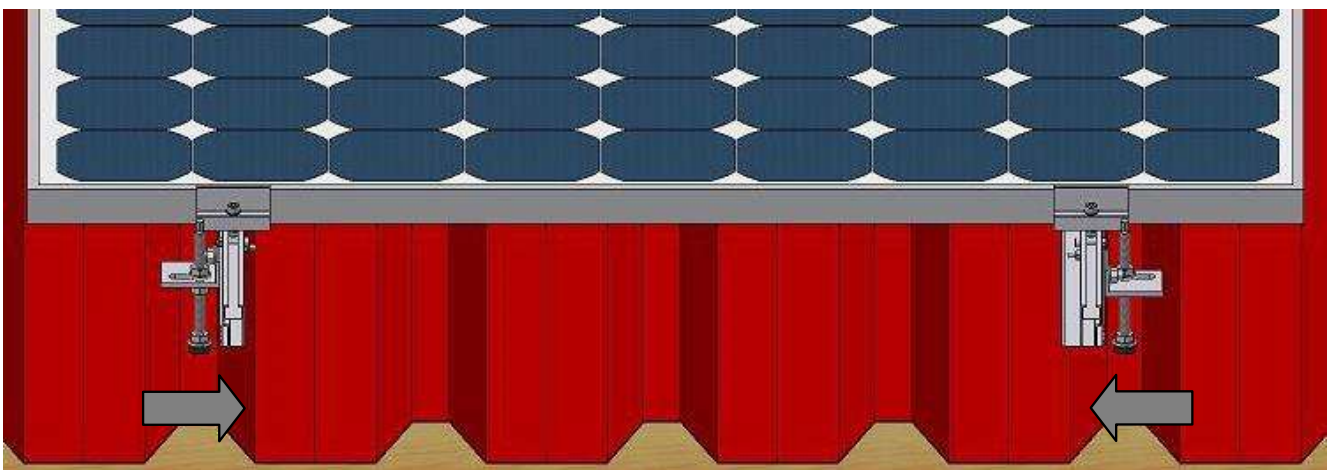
Montierte Stockschraube mit „Universalverbinder“
